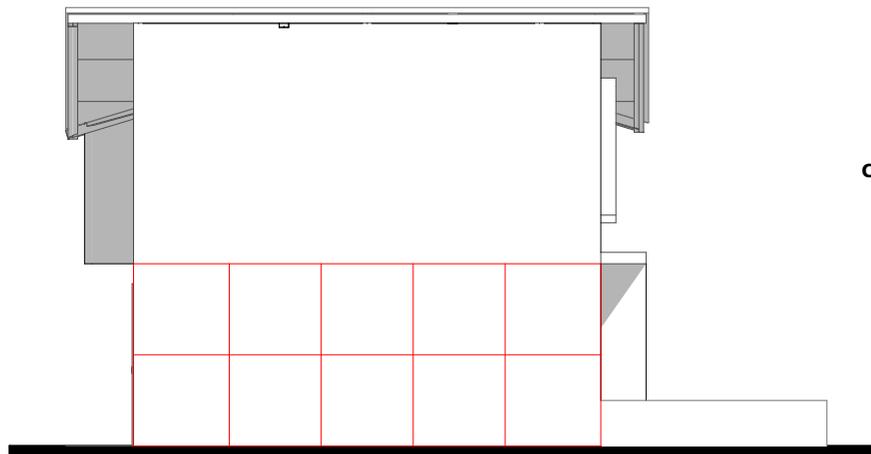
Modulaci3n de paneles en fachada lateral izquierda.
